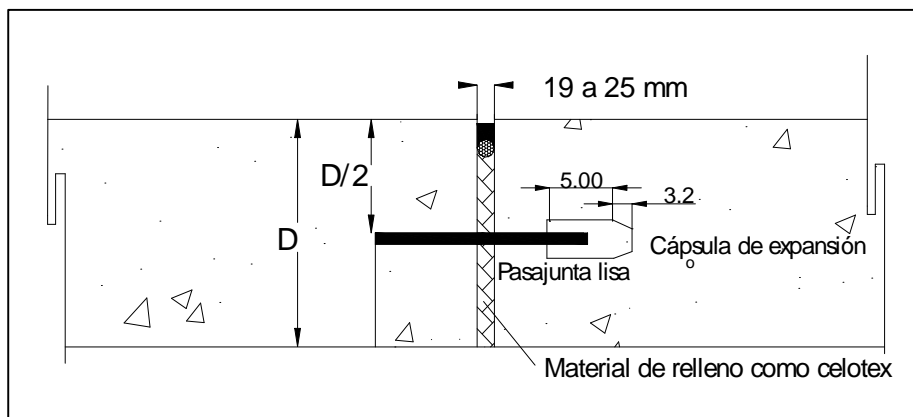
Junta transversal de expansión/aislamiento con pasajunta lisa.
